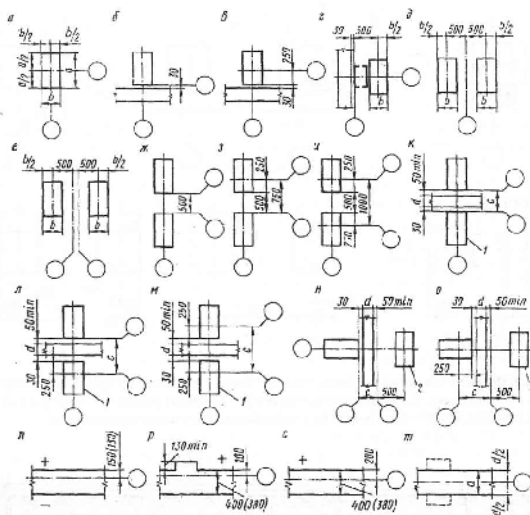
Привязка колонн и стен одноэтажных зданий к координационным осям: а – привязка колонн к средним осям; б, в – то же, колонн и стен к крайним продольным осям; г, д, е – то же, к поперечным осям в торцах зданий и местах поперечных температурных швов; ж, з, и – привязка колонн и вставки в продольных температурных швах зданий с пролетами одинаковой высоты; к, л, м – то же, при перенаде высот параллельных пролетов; н, о – то же, при взаимно перпендикулярном примыкании пролетов; п – т – привязка несущих стен к продольным осям; 1 – колонны повышенных пролетов, 2 – колонны пониженных пролетов при их торцовом примыкании к повышенным
